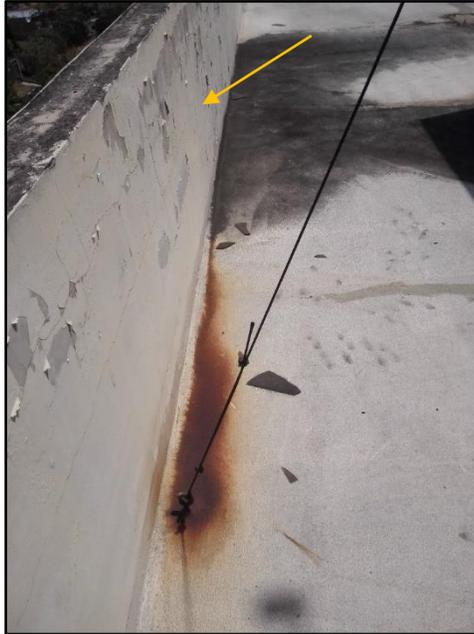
Parapeto ubicado en la terraza de la torre de hospitalización.
